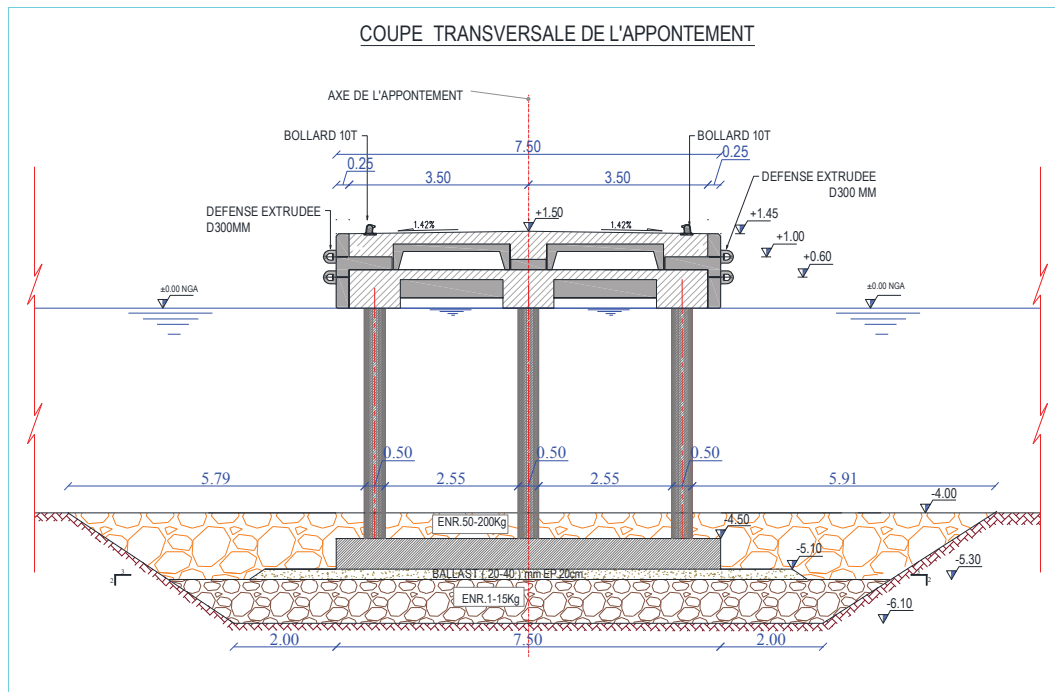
Coupe transversale de l'appontement à -2.90m
